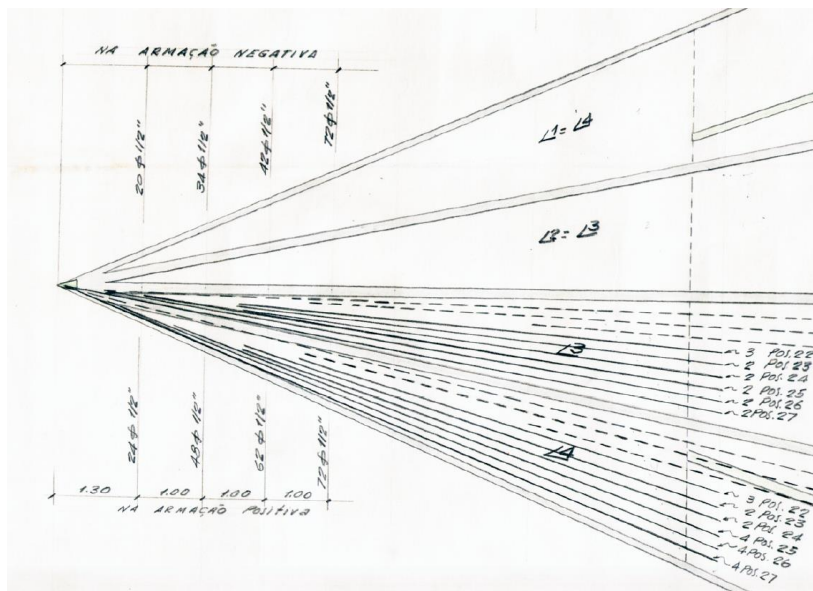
Planta de armação das lajes de cobertura. Fonte: Arquivo Público do Distrito Federal, 2022.
